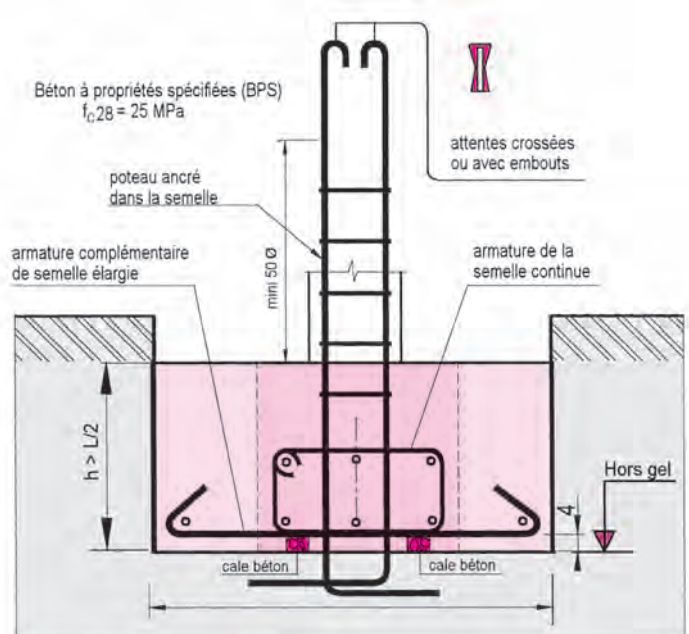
Semelle continue en BA élargie au droit du poteau
